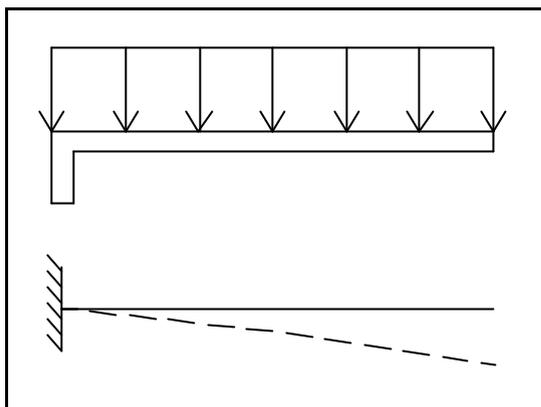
Corte de uma laje em balanço (Bordo livre)
